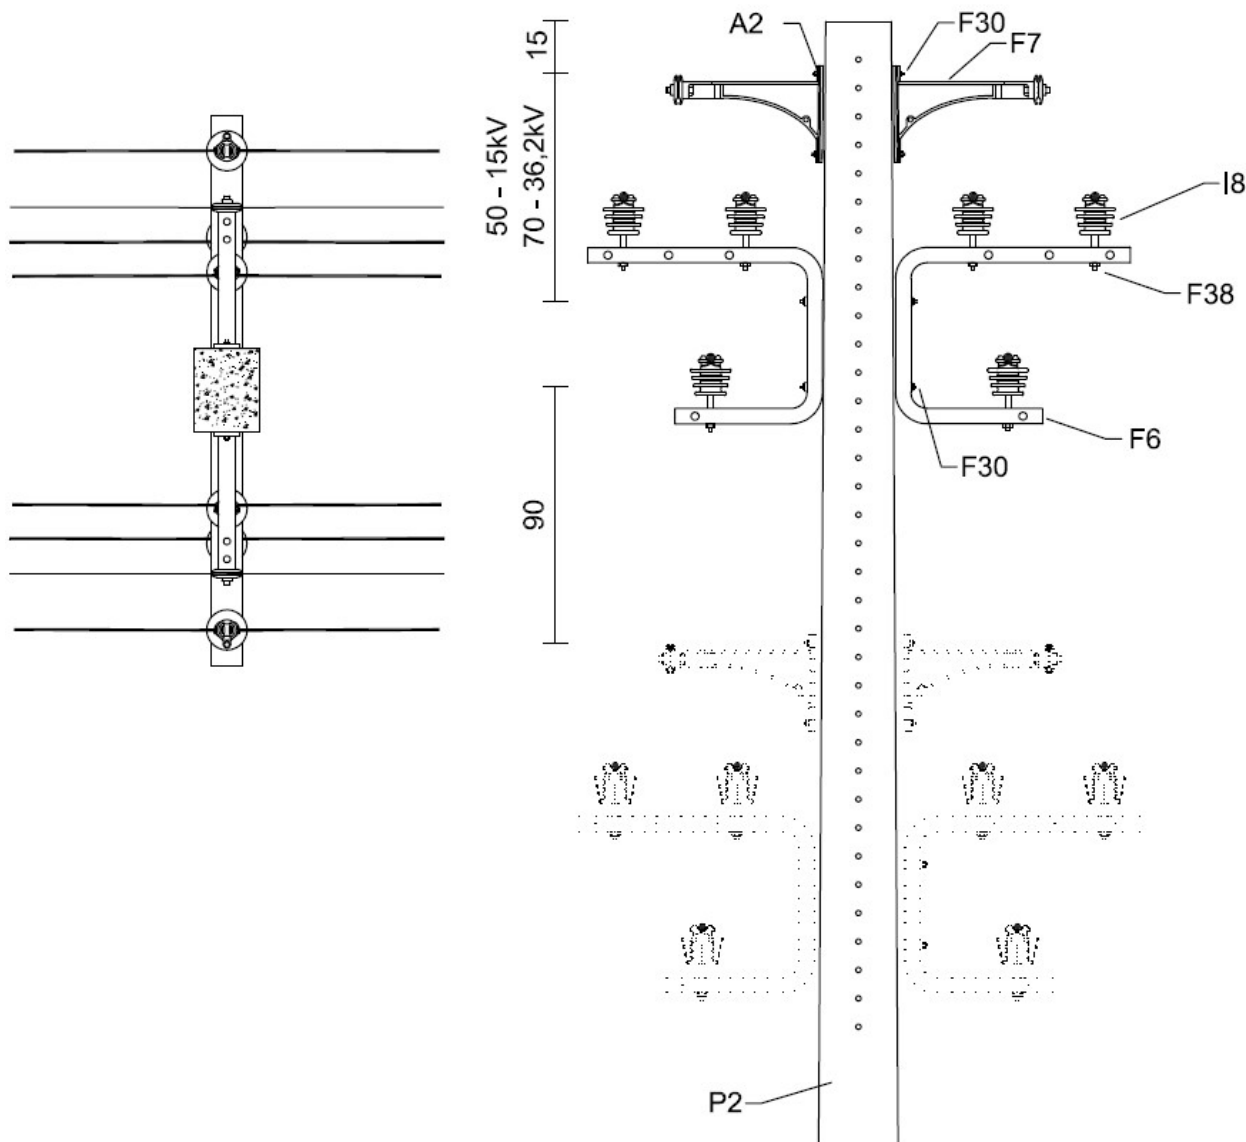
Estrutura CE2.CE2 – Poste de Concreto de Seção DT
